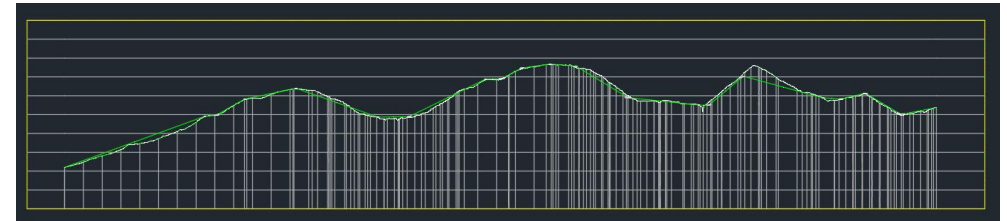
Diagrama de trazado en alzado. Fuente: Elaboración propia.
